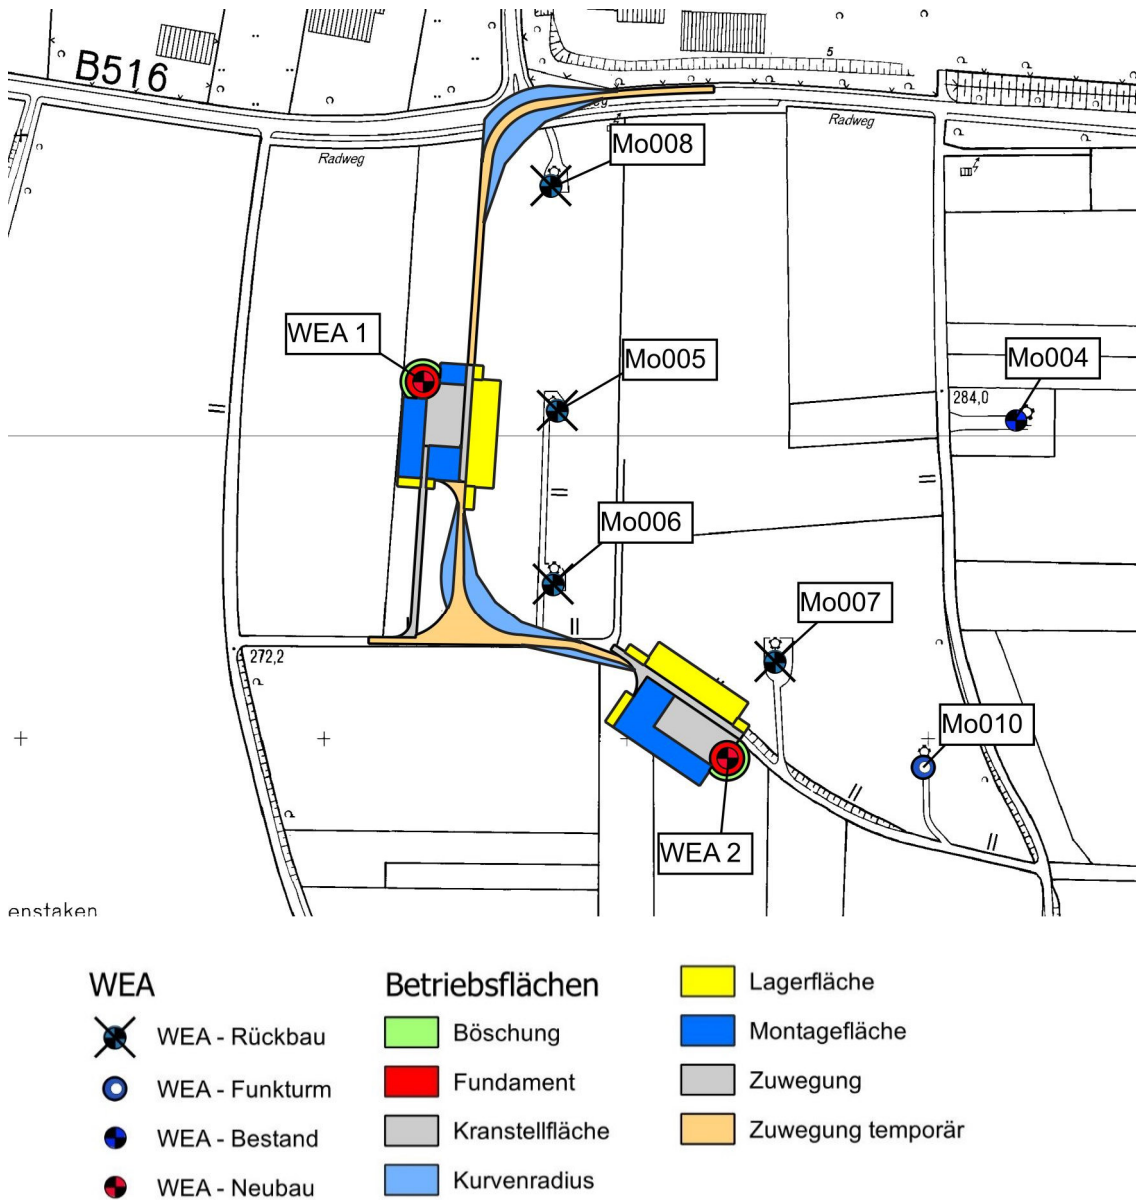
Übersicht über die Planung der Anlagenstandorte und der Betriebsflächen.
